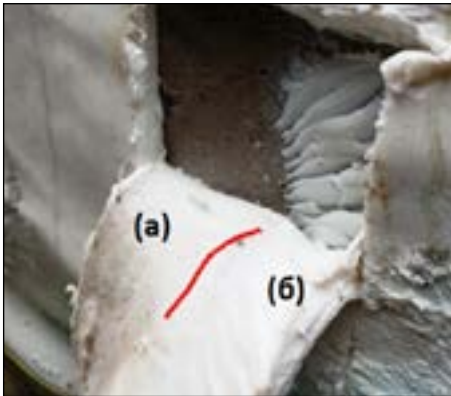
Демонстрация хорошей адгезии гидроизоляционной «мембраны» при попытке ее отделения от бетона
